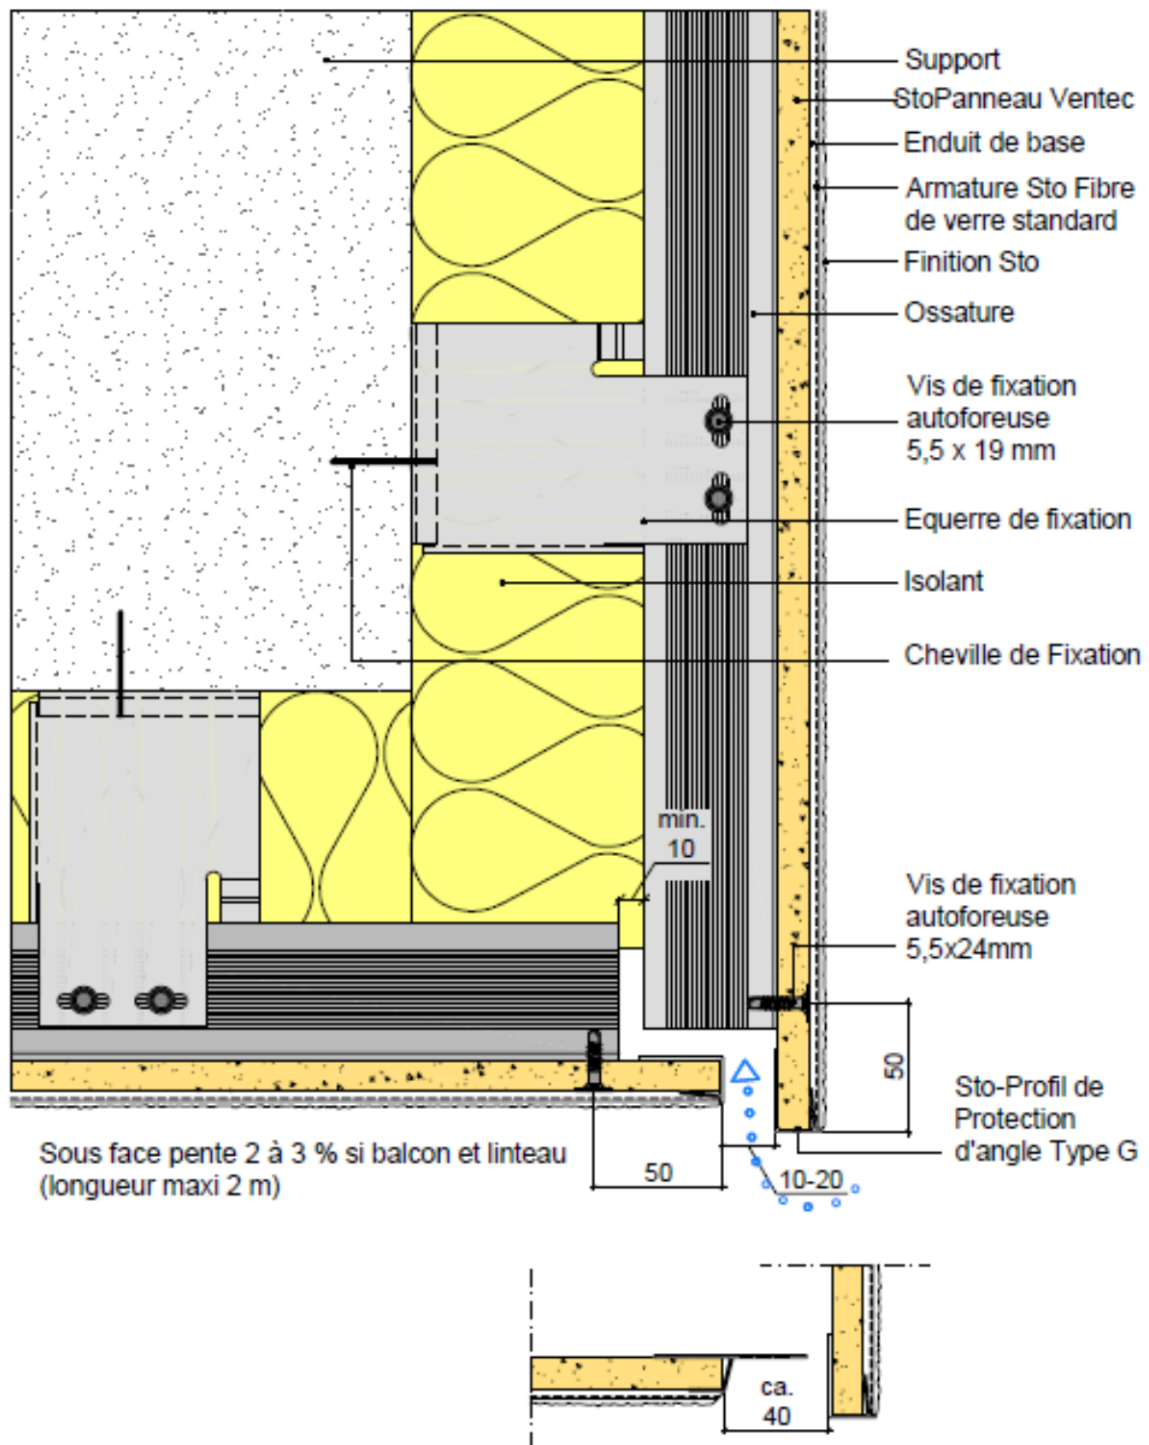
is – Coupe verticale - Pose en sous-face - Interface entre la sous-face et le bardage en retrait de la façade - Ossatures aluminium sur support béton
